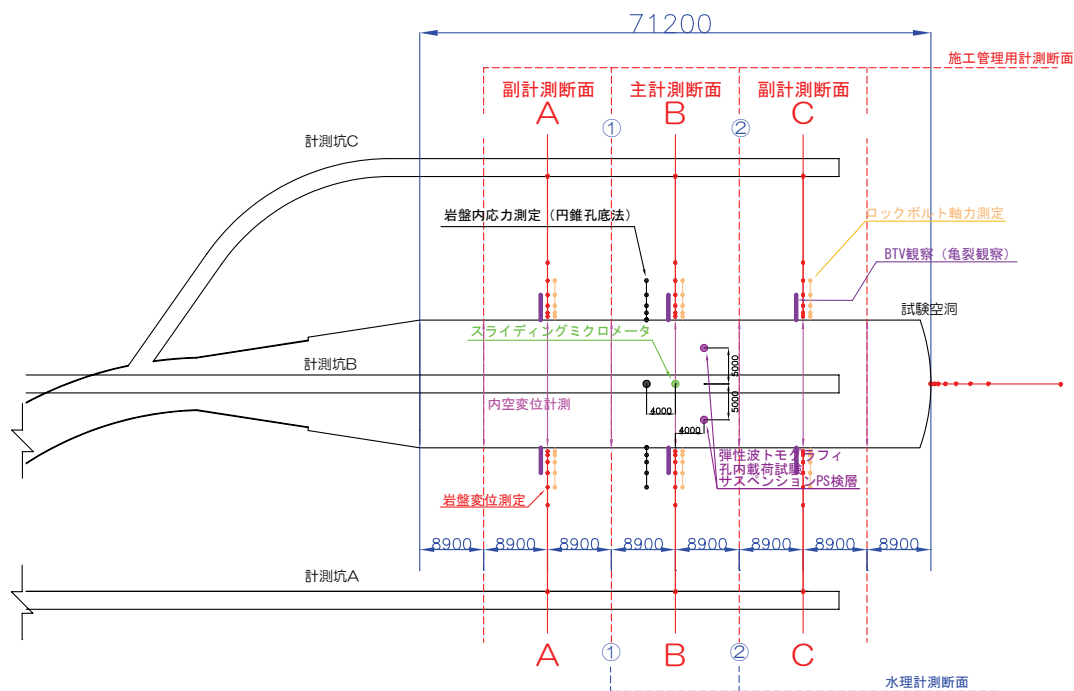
計測配置図（試験空洞平面図）³⁾
